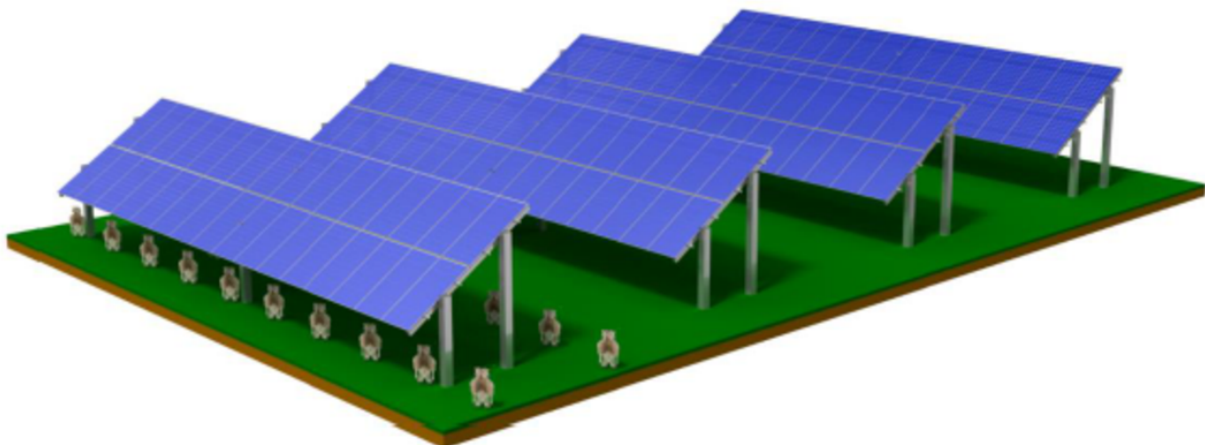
Vista Assonometrica della struttura "Fissa bassa (Ground Mounted T02)"
